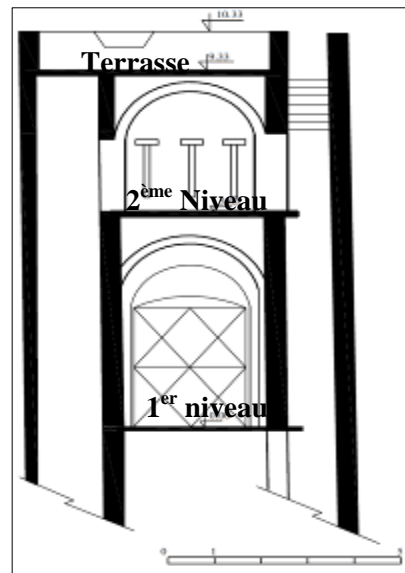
coupe longitudinale sur la porte Dar Essenaâ
